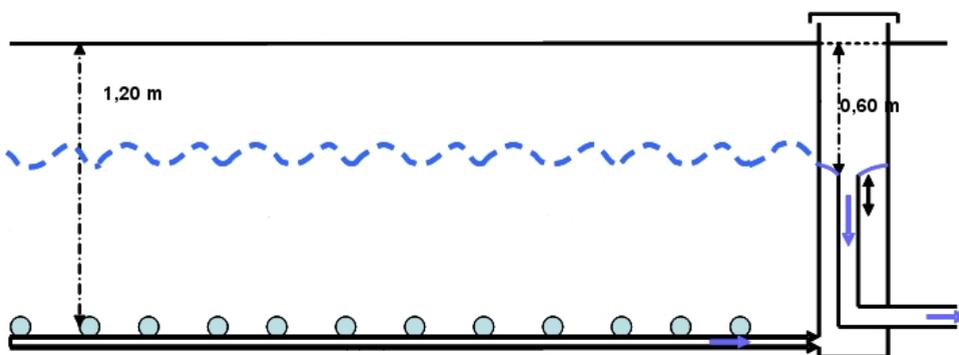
Drenaje controlado: drenaje profundo, drenaje recolector y tubería de cañería ajustable en pozo
